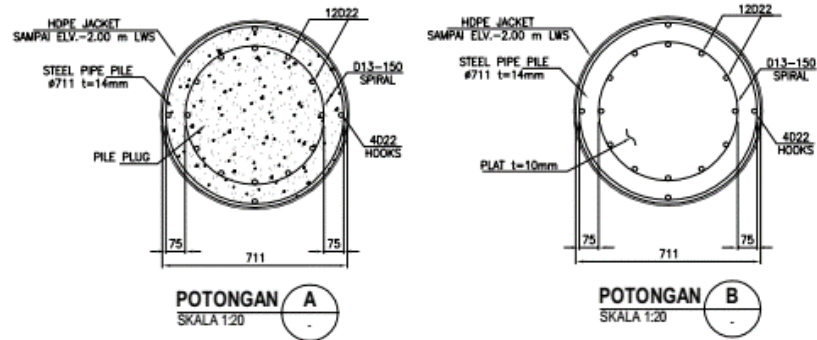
Detail potongan penulangan kepala tiang 812 jetty
